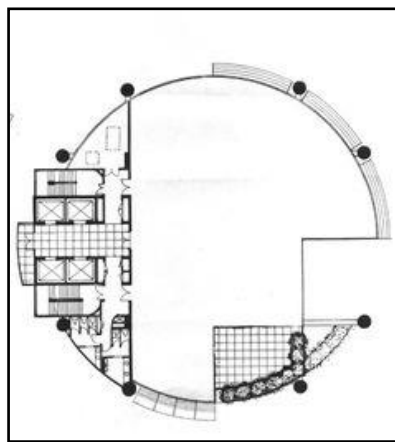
Site Plan Dan Denah Menara Mesiniaga
